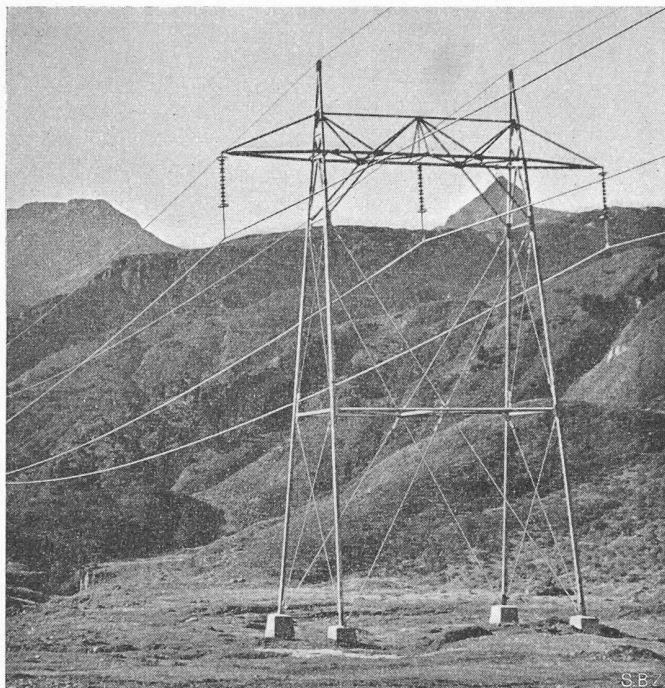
380 kV-Tragmast mit ausbetonierten Stahlrohren der Lukmanierleitung; Leiterabstand 10 m
